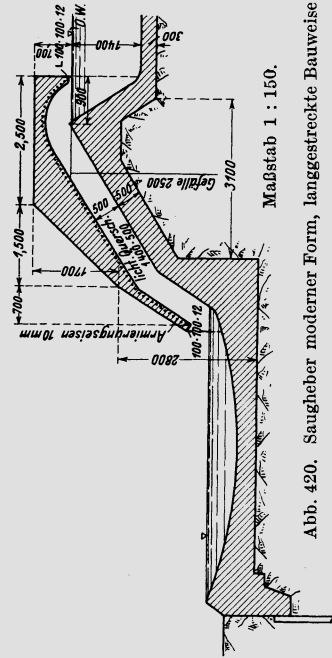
Saugheber moderner Form, langgestreckte Bauweise
